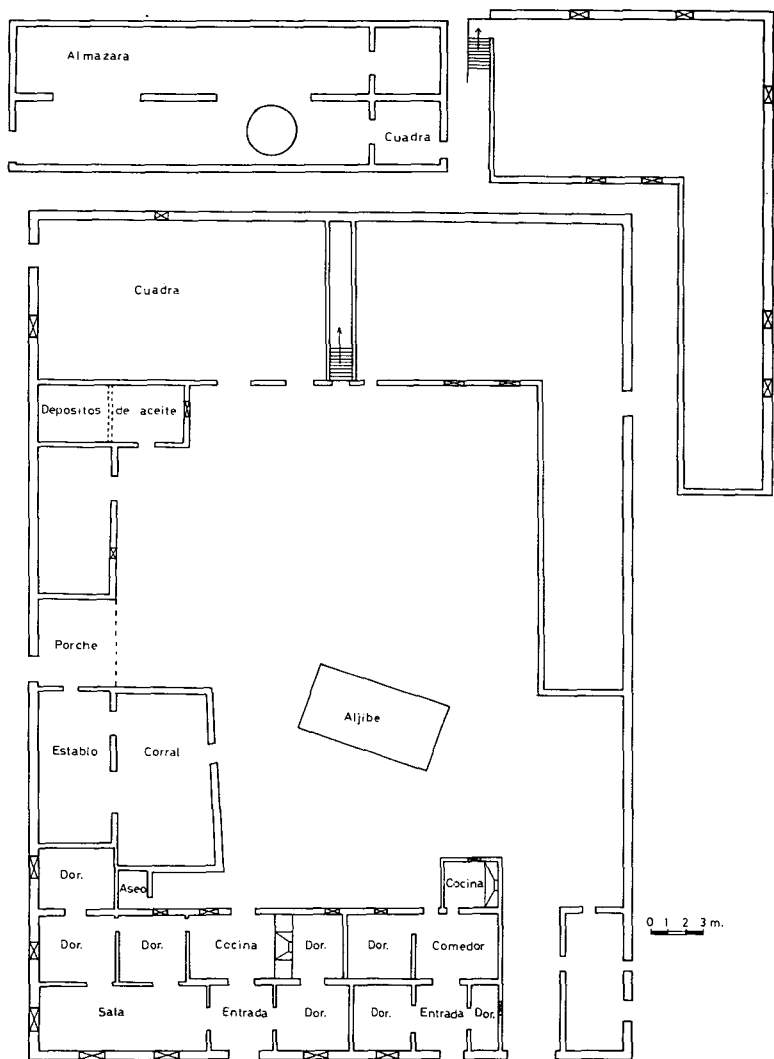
Detalle de la distribución de la vivienda construida en la finca «De Quiles».
